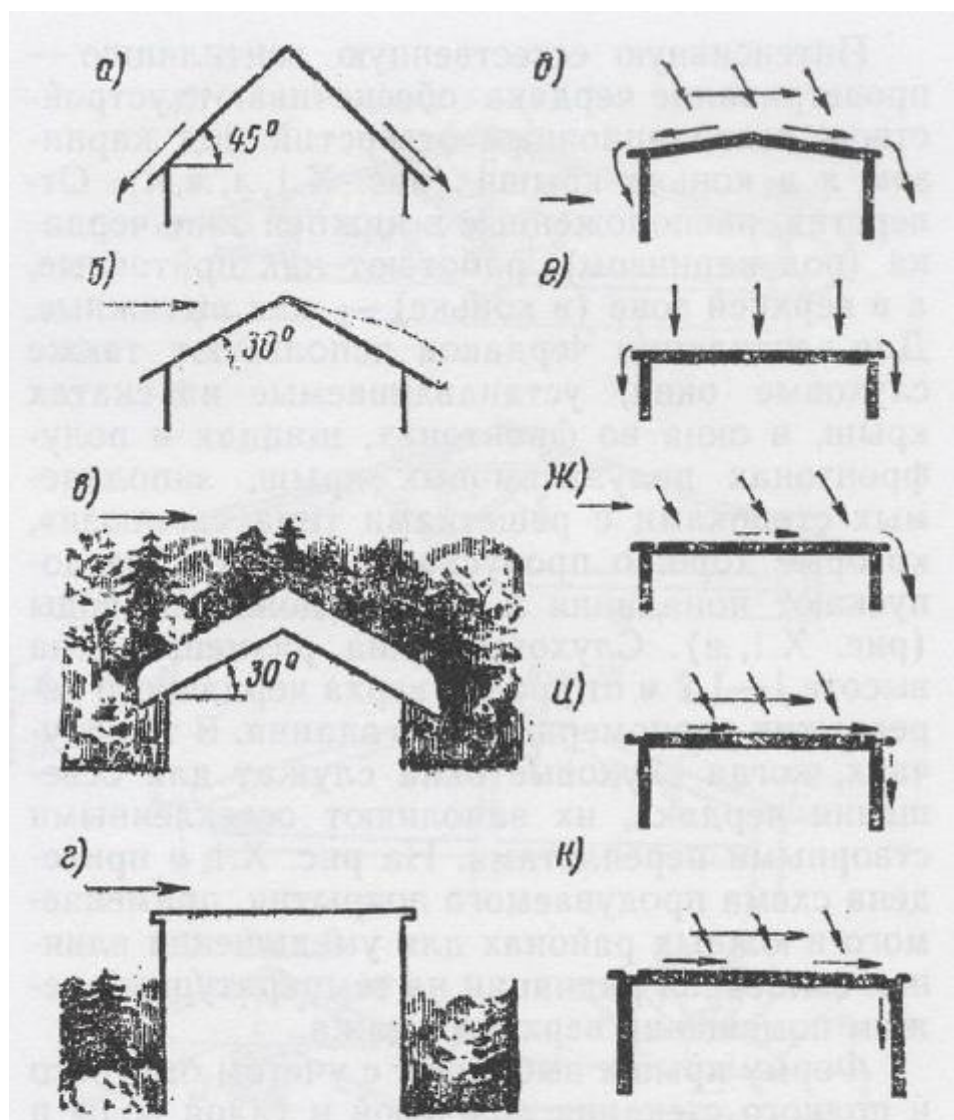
Схемы отложения снега на крышах разной формы и стекания с них воды
